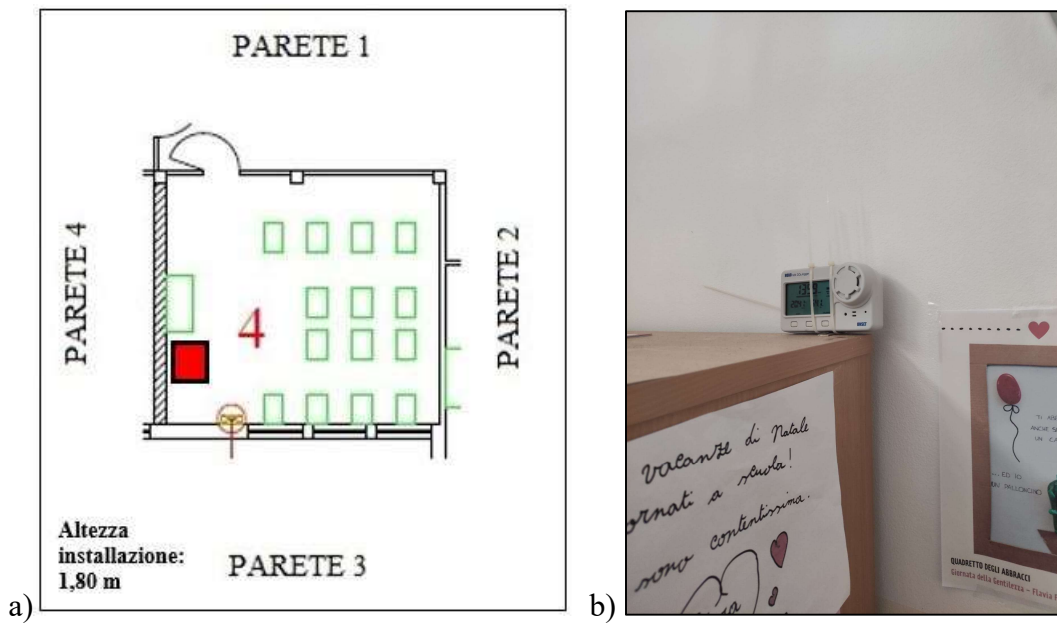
Posizione acquirente in pianta (a) e in foto (b) Aula 4 (2°A)
